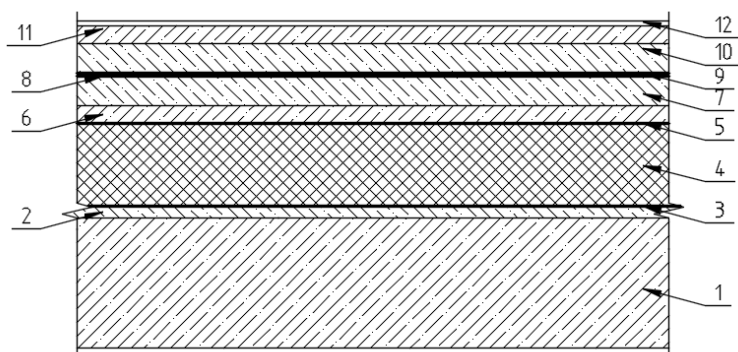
Схема покрытия эксплуатируемой кровли
